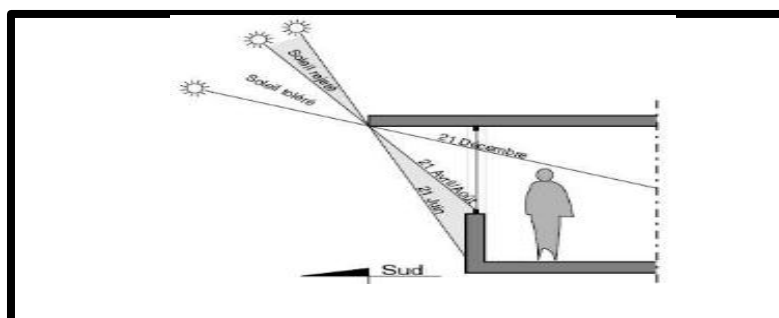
Protection fixe par une avancée de toit en façade sud.
